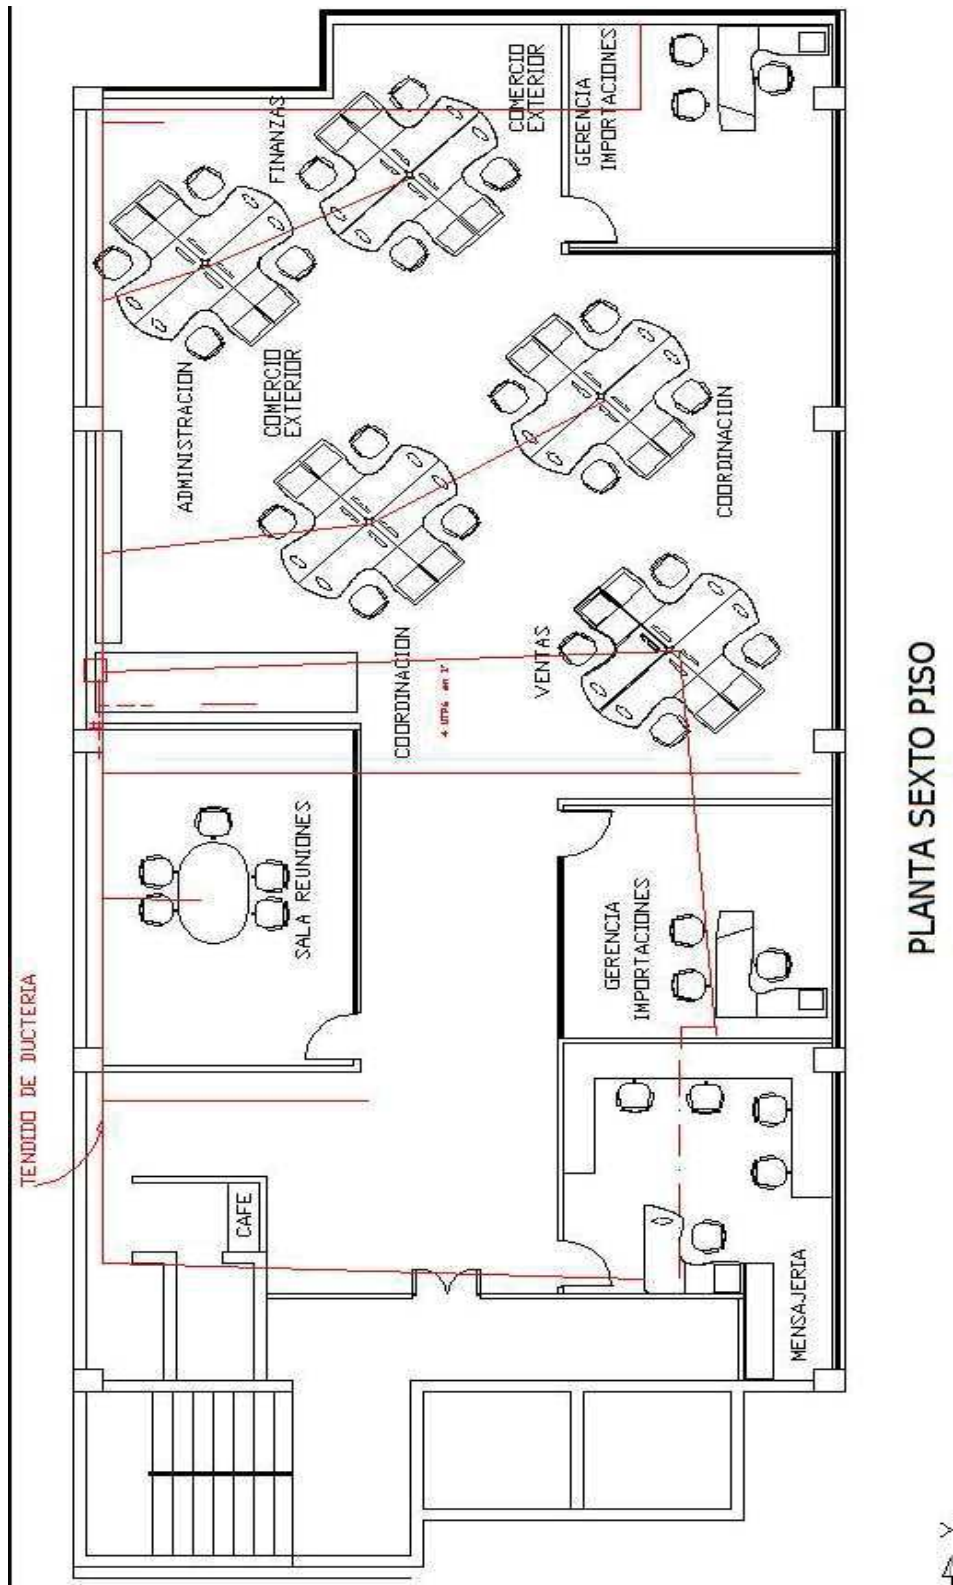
Distribución ductería propuesta Sexto Piso.
